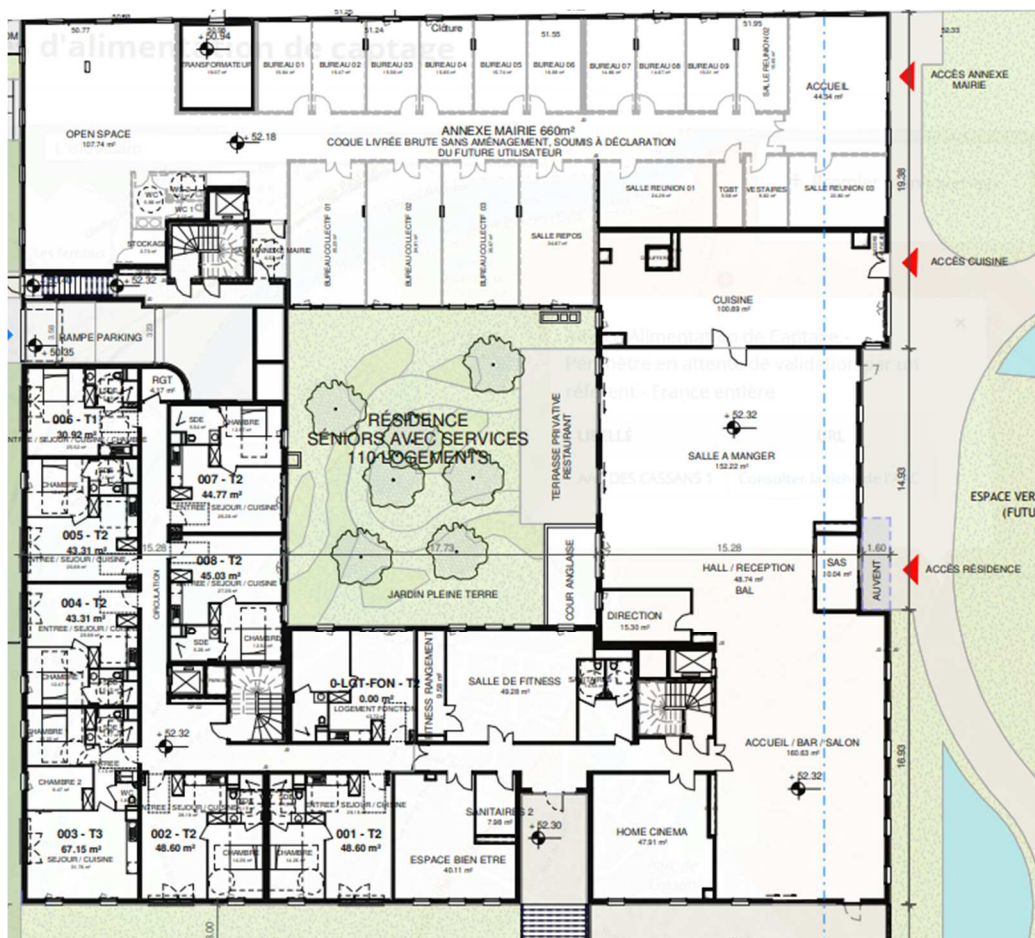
Plan du rez-de-chaussée de la résidence senior services, Studio d’Architecture Galliot-Vannier
